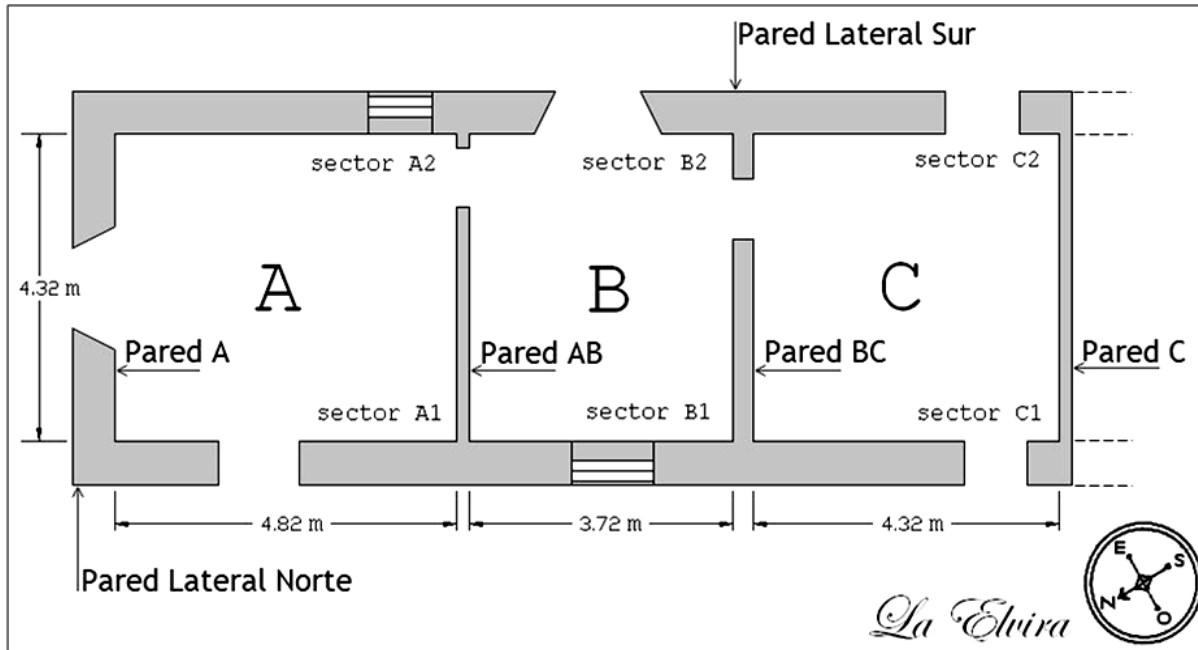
Plano general, con el detalle de la denominación de cada sector relevado
